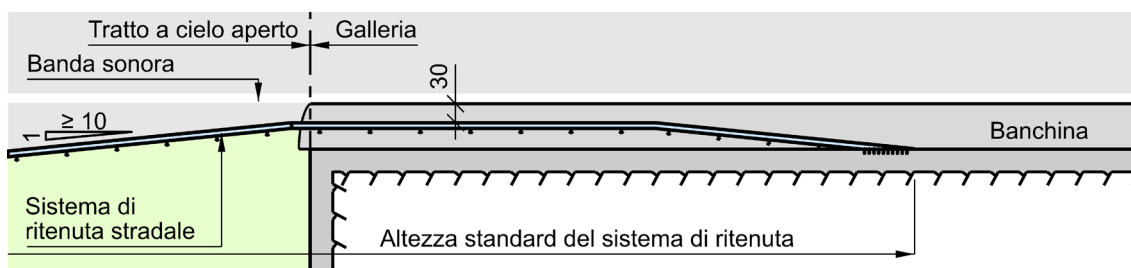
Variante 2c – Barriera elastica portata all'interno della galleria e fissata alla parete
